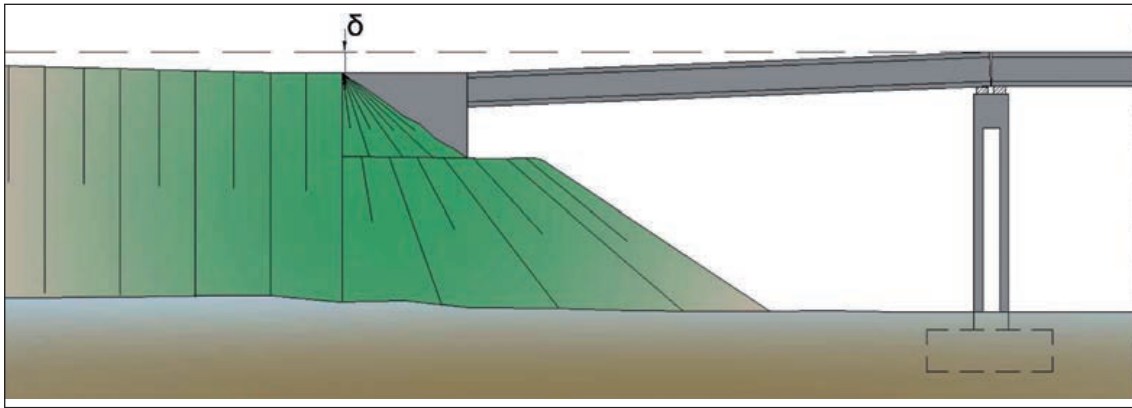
ASIENTO DE ESTRIBO DE CARGADERO FLOTANTE.
